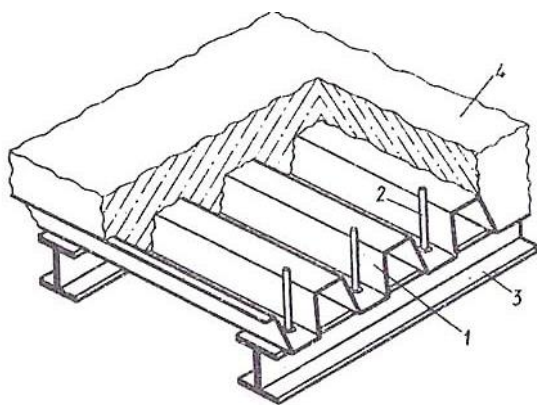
Плити з настилами та опалубкою з оцинкованих трапецеїдальних профільованих настилів без виштамповок: 1 – профільований настил; 2 – анкерний упор; 3 – сталева балка; 4 – бетонна плита.
